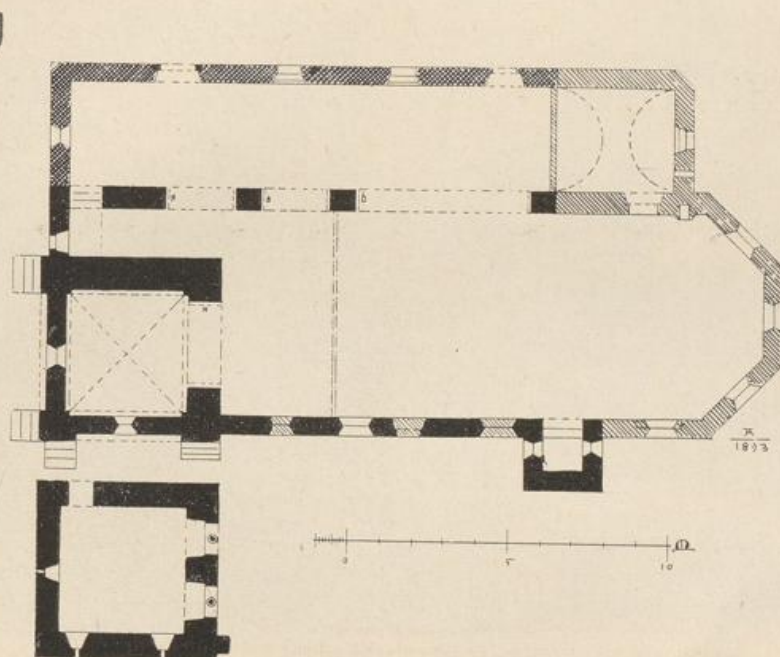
Nieder-Zündorf. Grundriss der alten katholischen Pfarrkirche.
